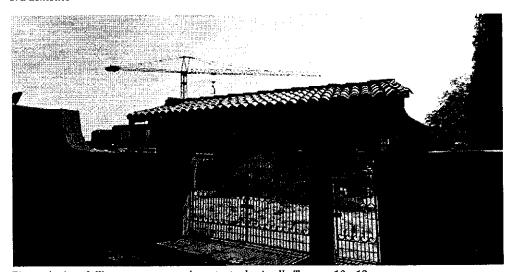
vista dell'accesso coperto ed arretrato da via alla Torre n. 10 e 12
